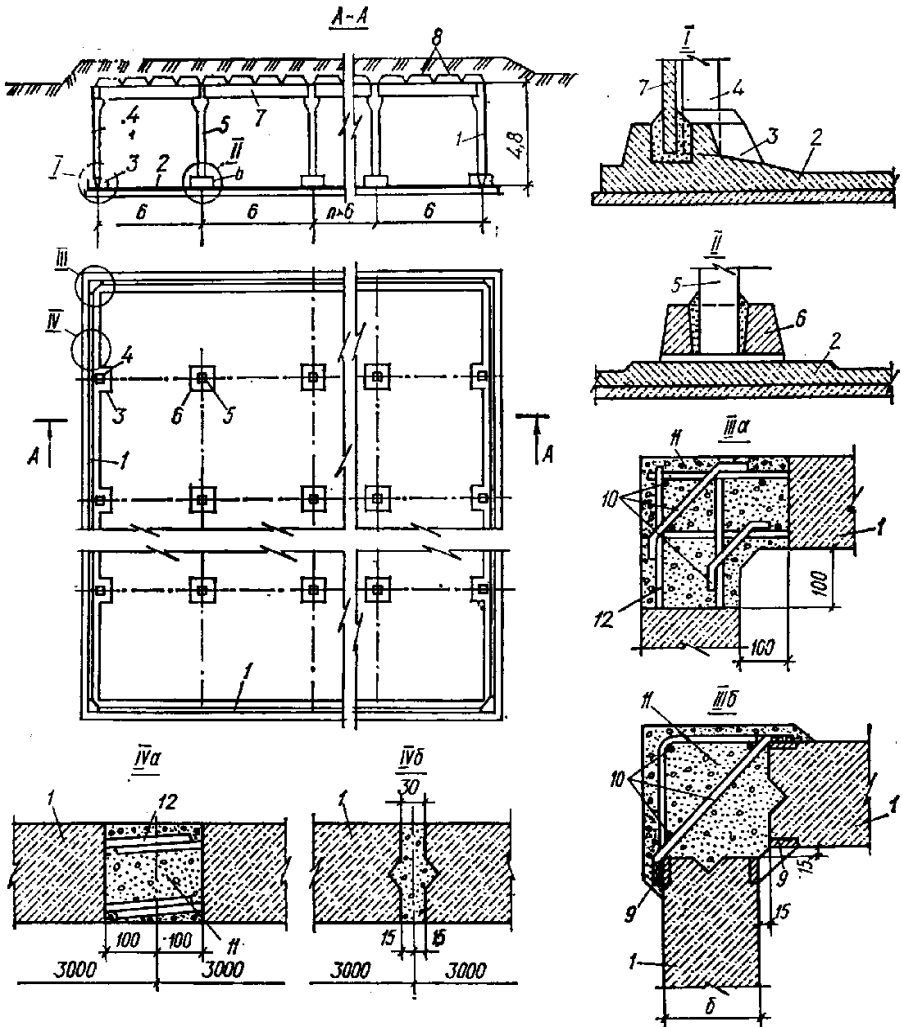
Прямокутний резервуар з уніфікованих збірних залізобетонних елементів: 1 – стінові панелі; 2 – монолітне дно; 3 – фундамент крайньої колони (прилив до дна); 4 – крайня колона; 5 – проміжна колона; 6 – фундаментний блок; 7 – ригель; 8 – плити покриття; 9 – закладні деталі; 10 – додаткова арматура в монолітній ділянці; 11 – бетон замоноличування; 12 – випуски арматури
